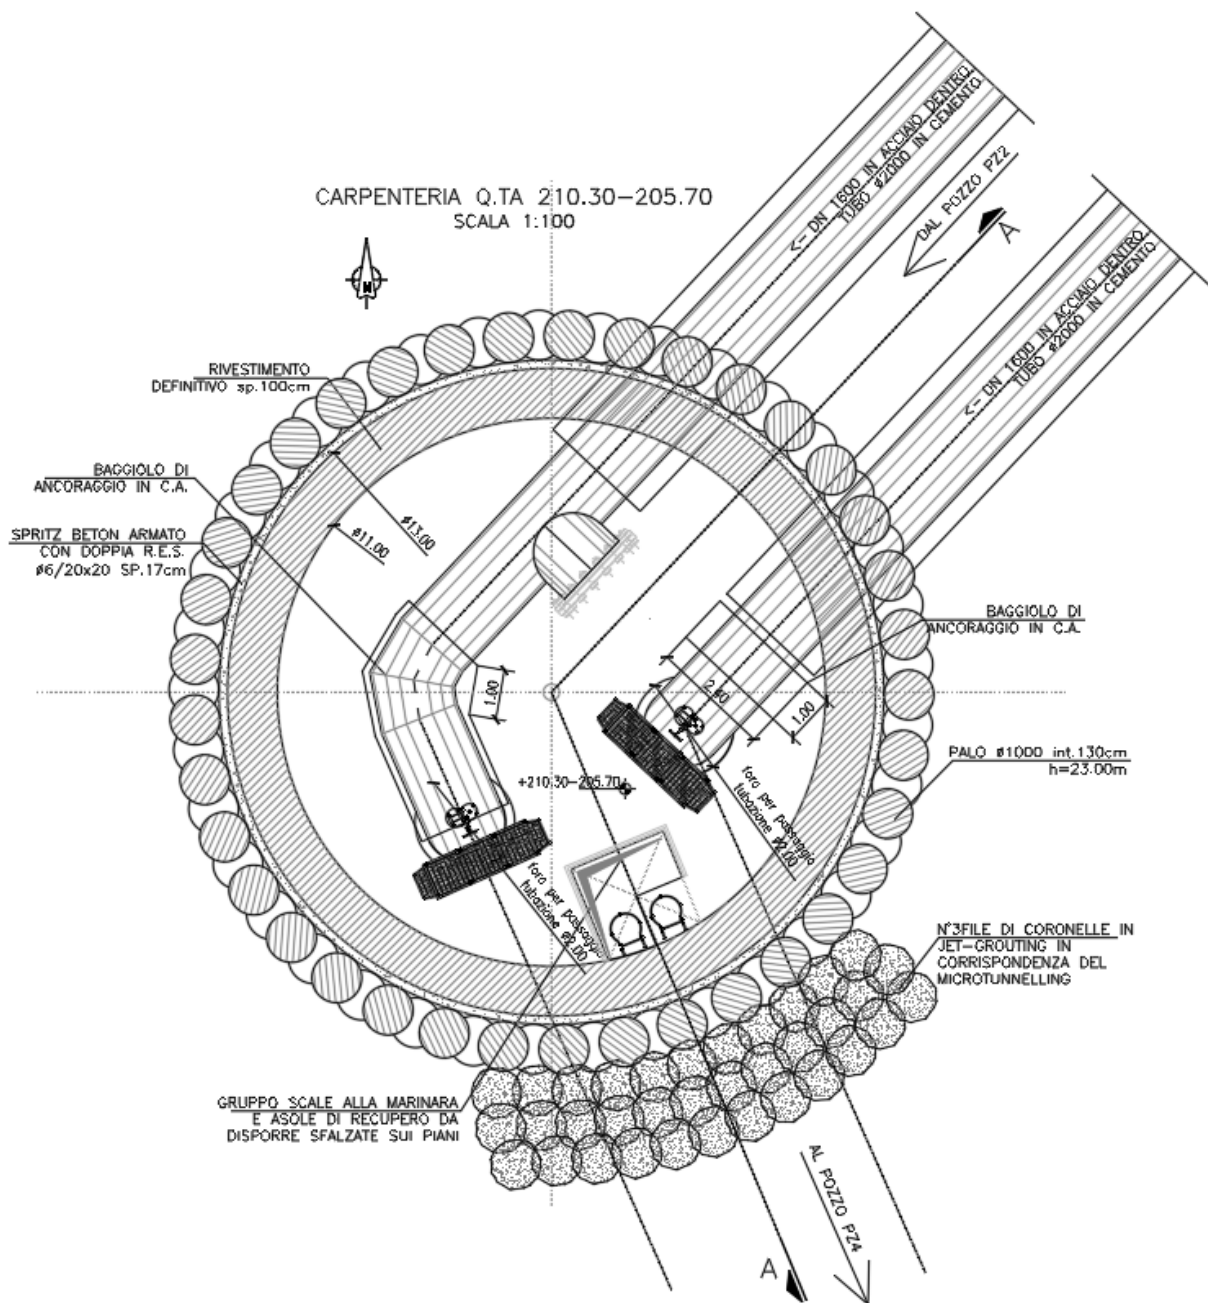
Rappresentazione in pianta del manufatto PZ3 – arrivo tubazioni
